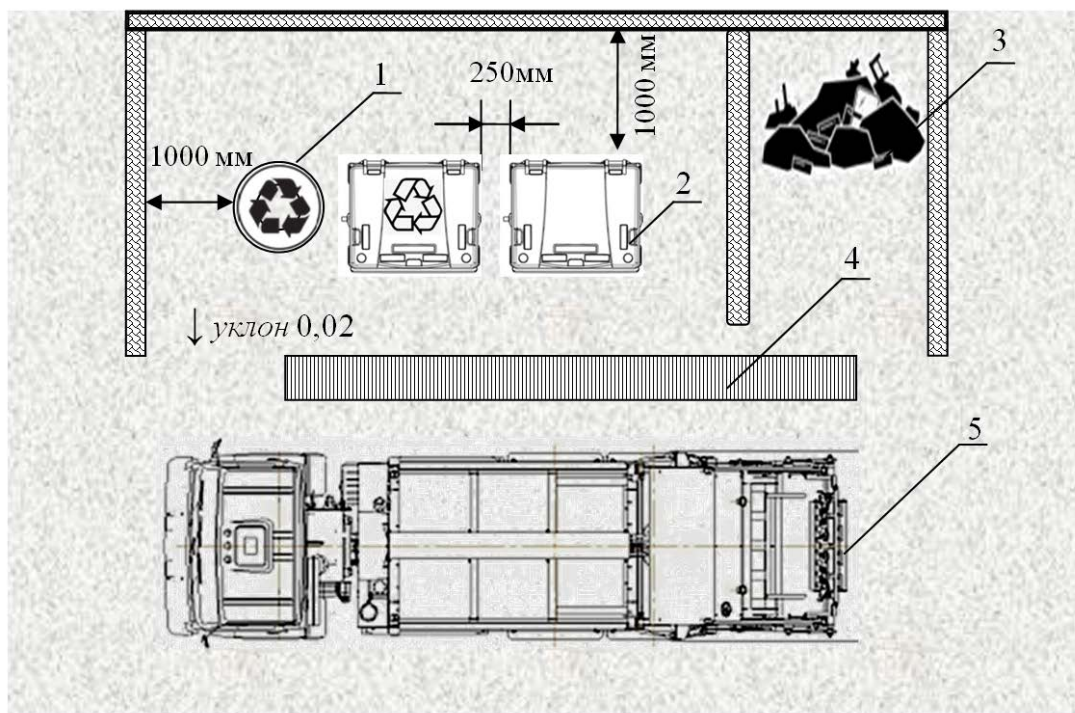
Примерная схема контейнерной площадки с бетонированным покрытием:
